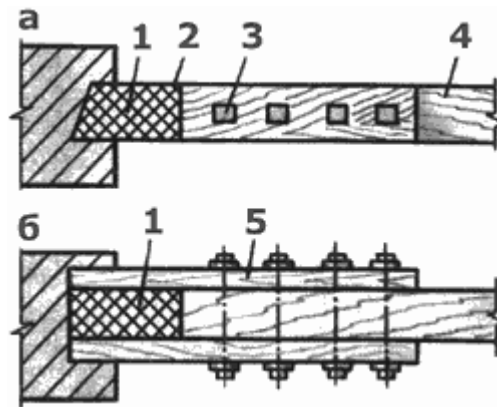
Укрепление конца деревянной балки боковыми накладками:1 - подгнившая ослабленная часть балки; 2 - граница загнивания; 3 - болты крепления; 4 - основная балка; 5 - боковые накладки.
